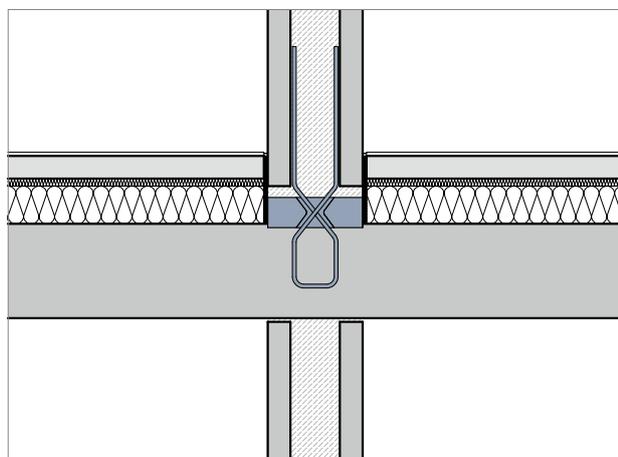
Représentation schématique d'un système Schöck Sconnex® type W pour doubles murs et isolation sur la dalle
